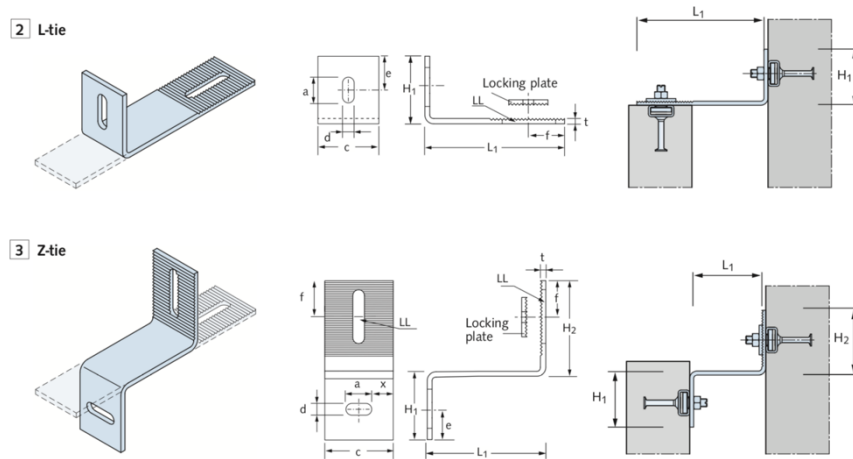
Acessórios de fixação nos painéis pré-fabricados de betão, HALFEN
